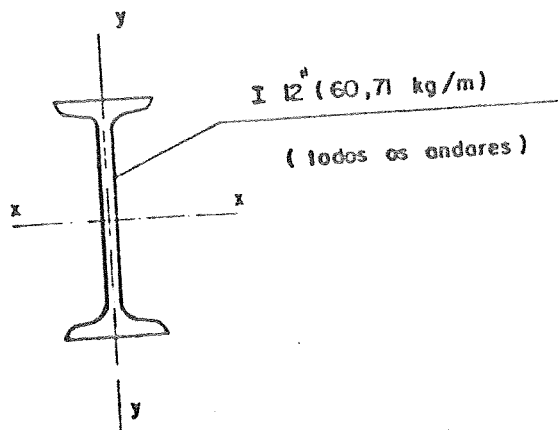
Tipo de perfil usado em todas as vigas das estruturas do grupo 1.
